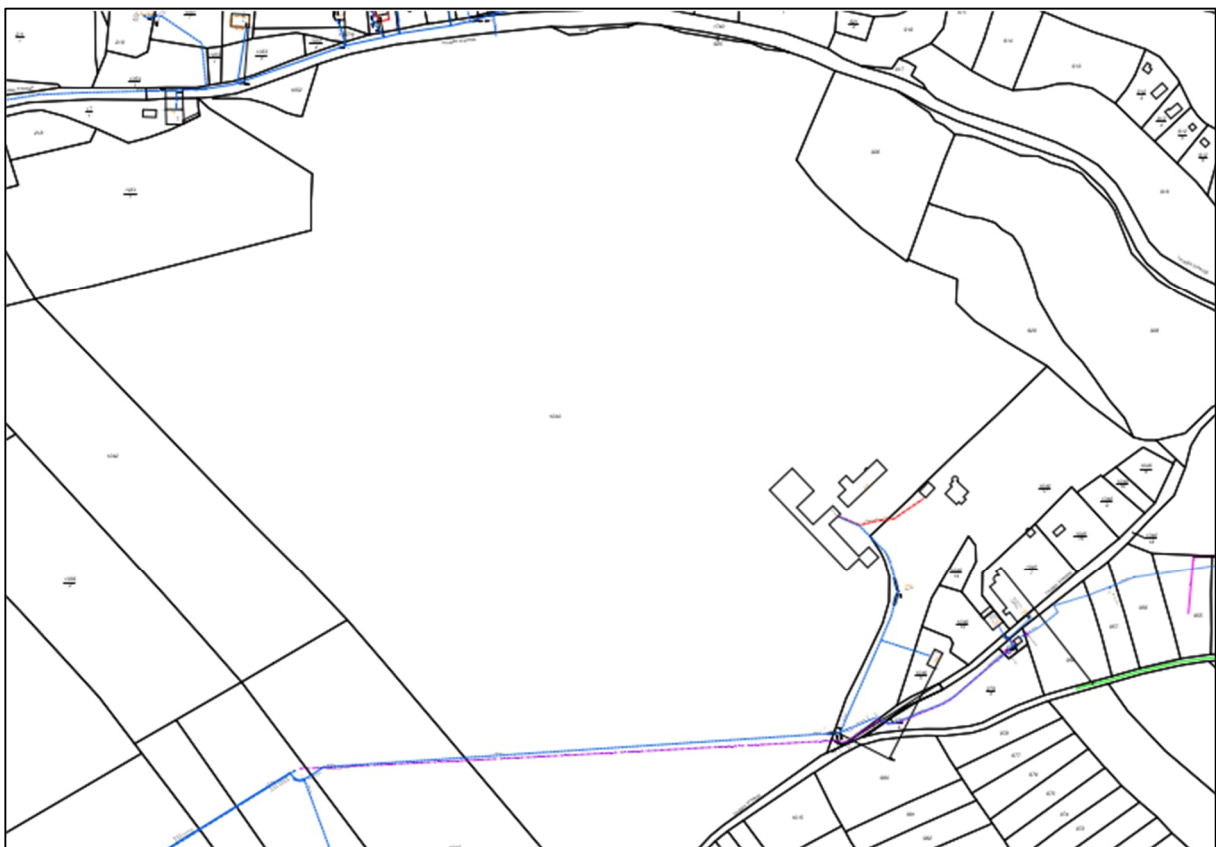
Lageplan ETW zum Leitungsbestand⁷
